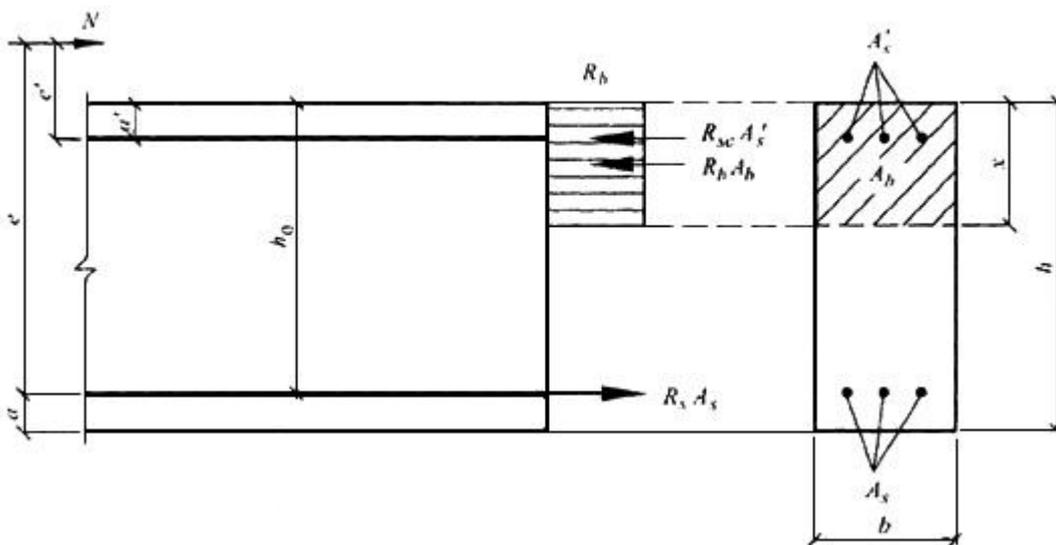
Схема усилий в поперечном сечении внецентренно сжатого элемента.
